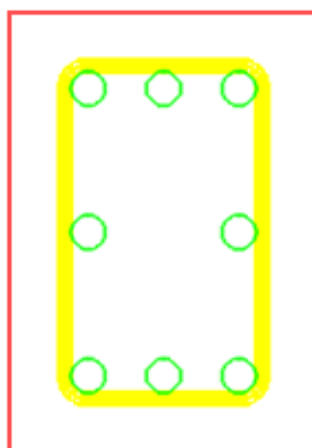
Perfil transversal - barra (Piso 1 – Piso 2).
